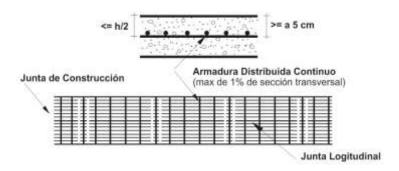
PCH con Refuerzo Continuo Fuente: Acurio. 2012
